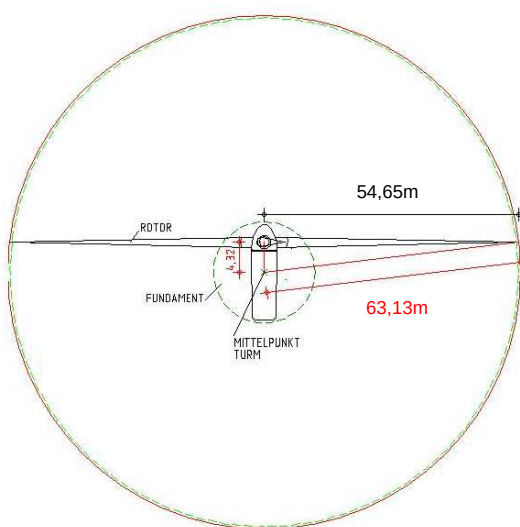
Grundrissplan WEA Vestas V-126, Quelle Vestas
